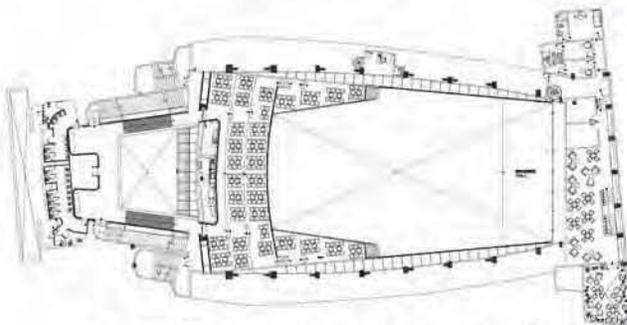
Planta acceso a zona de gradas y palcos.
